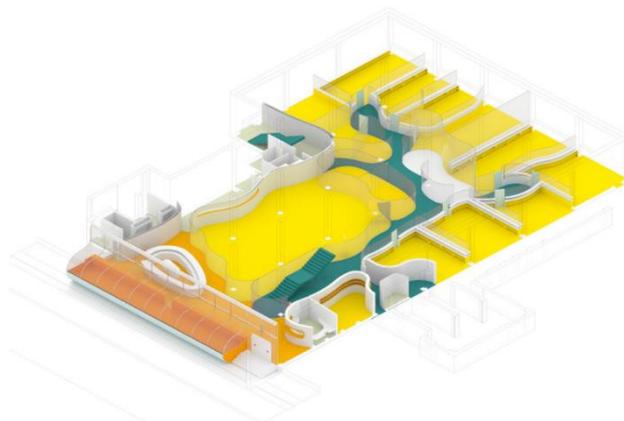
Planta baixa esquemática do escritório Secondhome.
